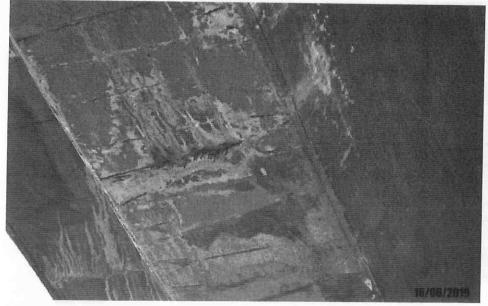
Detalhe de armadura exposta e fissura na face inferior da viga principal.
